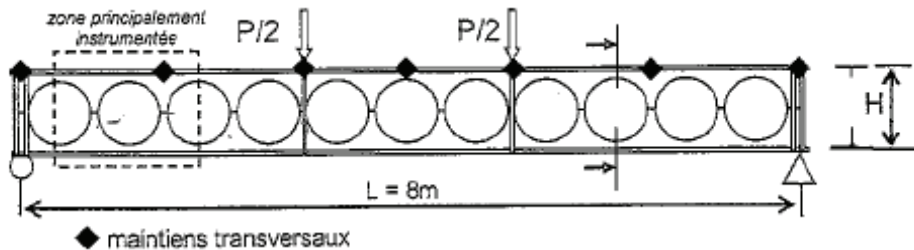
Essai sur une poutre cellulaire en acier [22]
